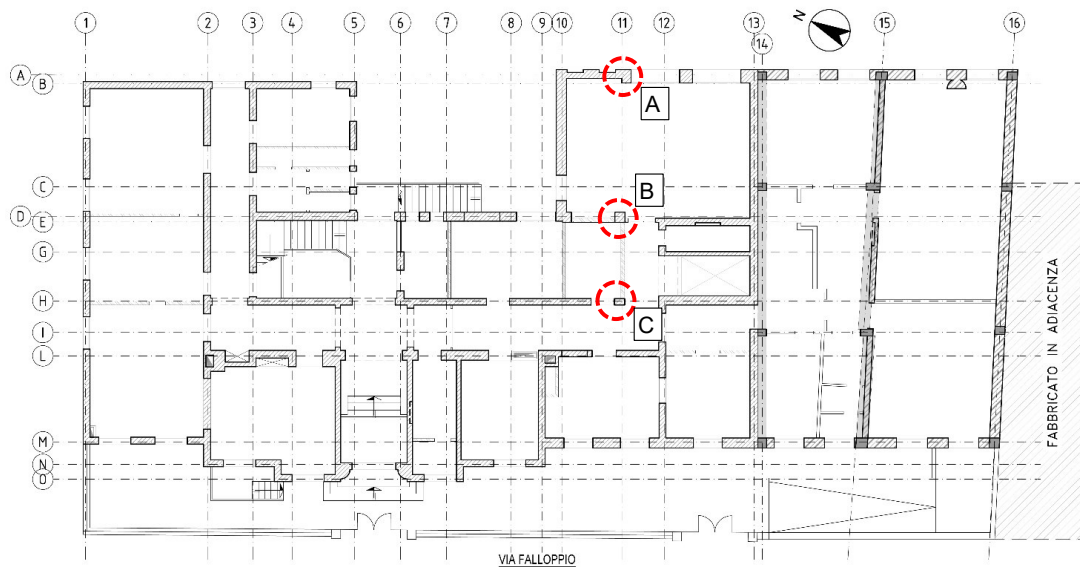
Pianta piano terra con individuazione degli elementi in muratura
